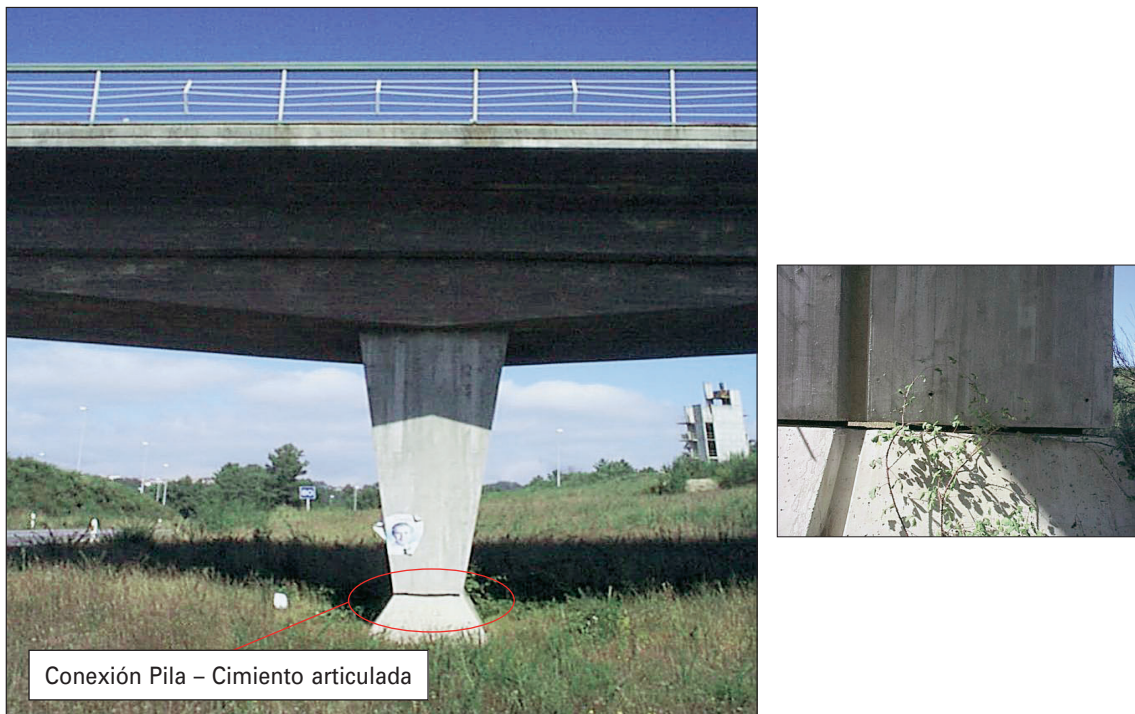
Y N.º 70. CONEXIÓN PILA – CIMIENTO ARTICULADA.
